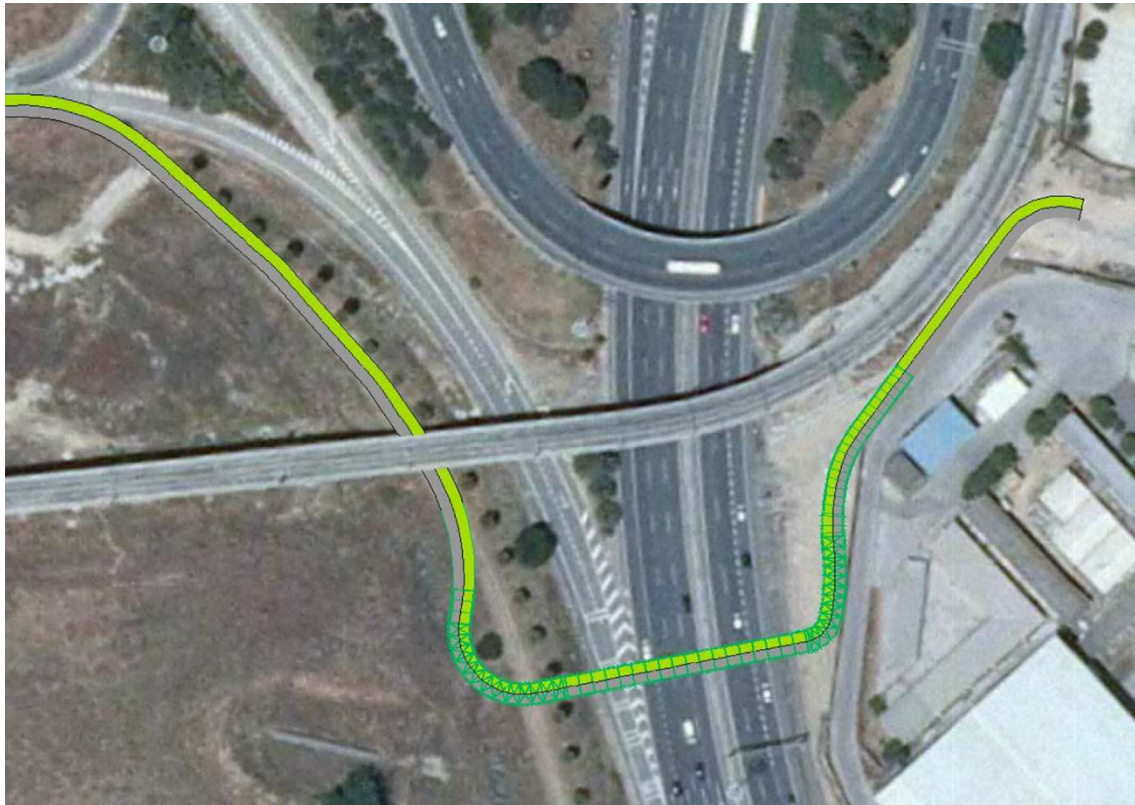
Planta de la actuación en el segundo proyecto de la Junta de Andalucía (02/2016)
